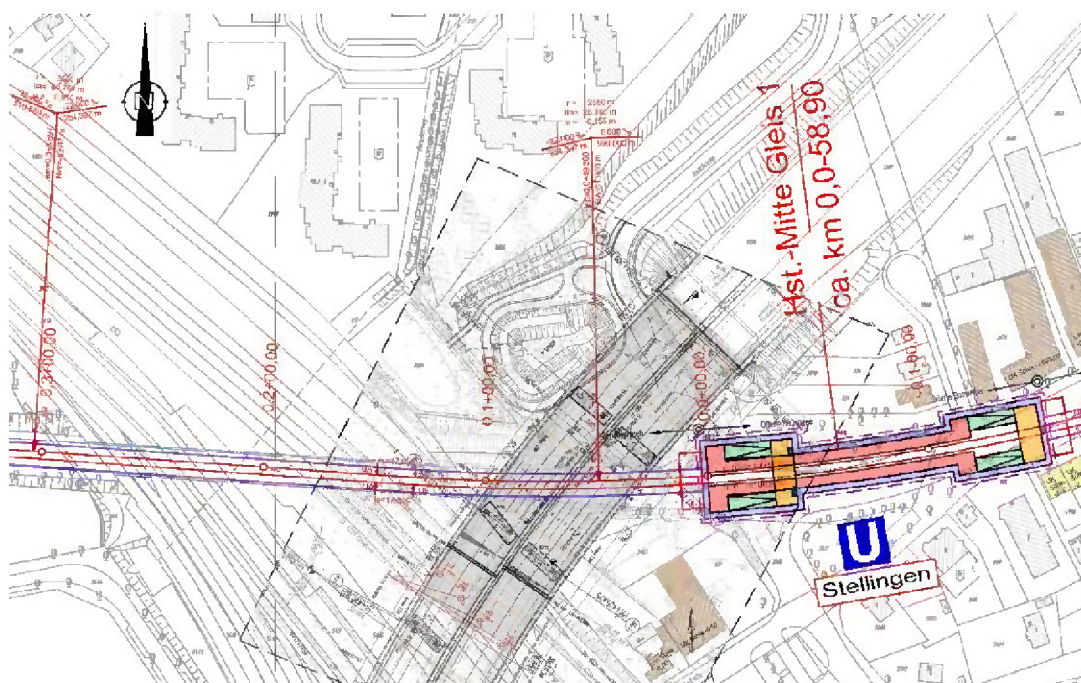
Haltestellenplan Stellingen und Unterquerung BAB A7 und DB-Gleisanlagen (Stand: 04.2019)
